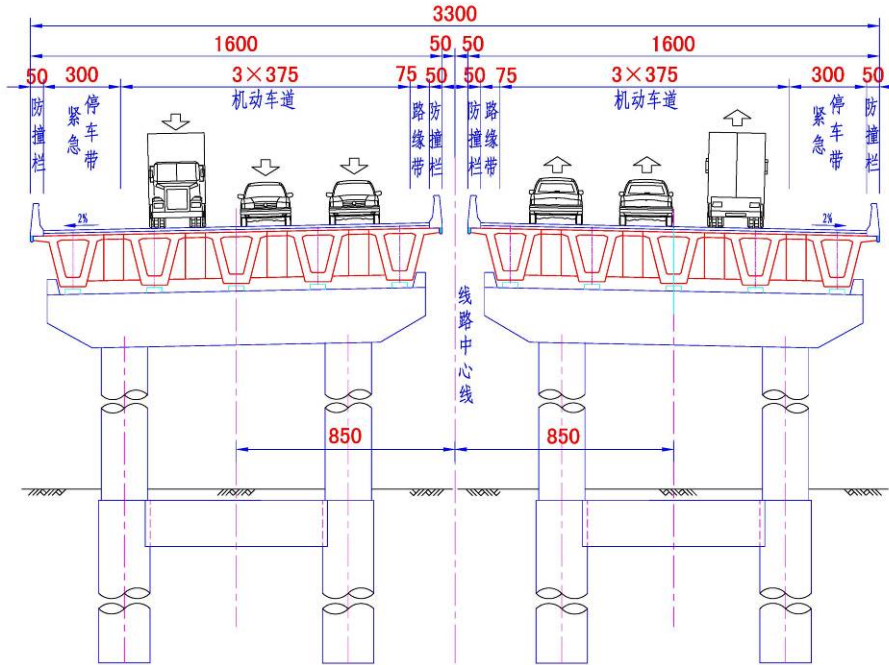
北接线桥梁横断面图 (单位: cm)
